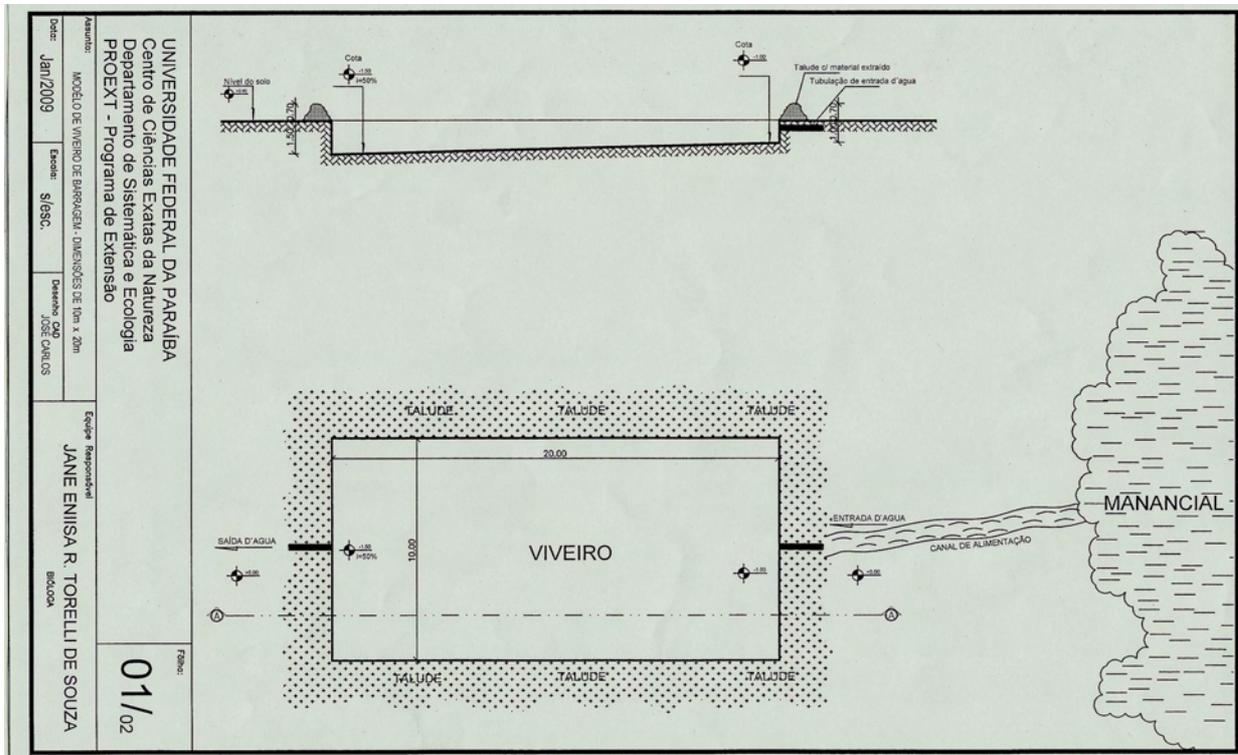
Desenho esquemático do modelo para construção do viveiro Fonte: José Carlos Ribeiro.
